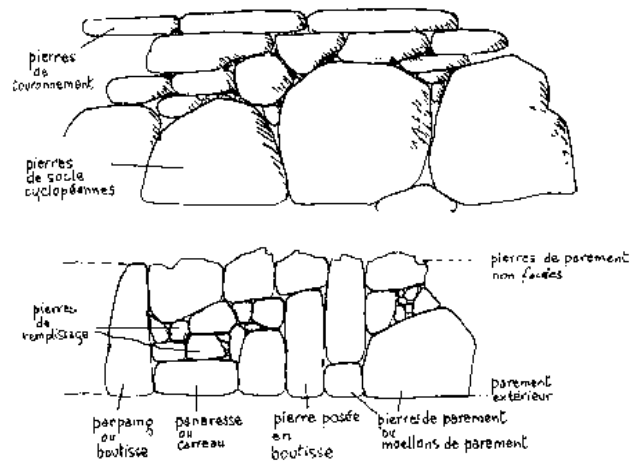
Désignation des pierres disposées dans le mur : élévation (haut) et coupe horizontale (bas) [2]
